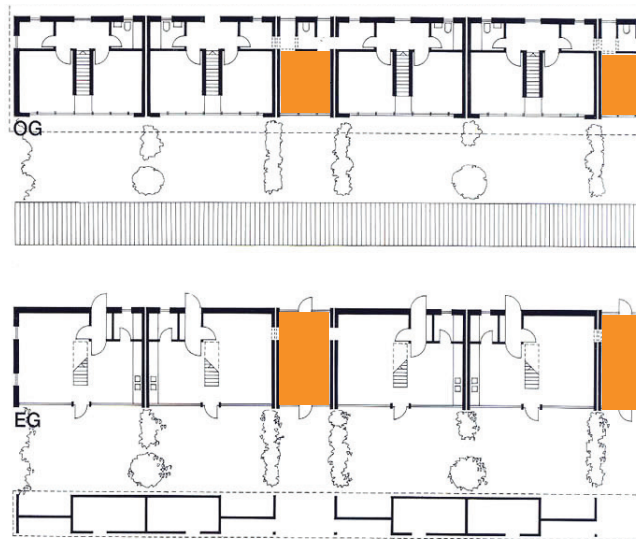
Grundrisse Wohnsiedlung Röthenbach
